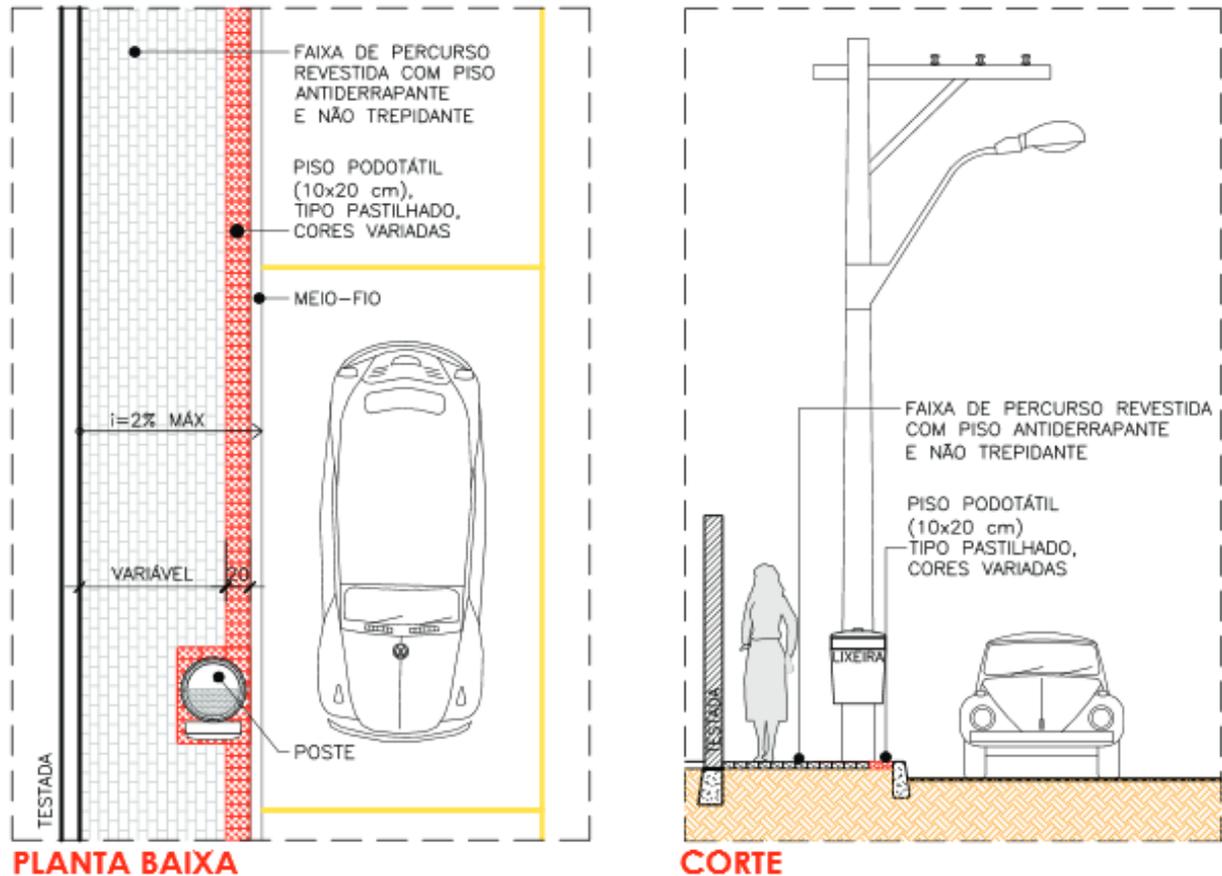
Planta baixa e corte de modelo de calçada com até 1,50m de largura.
